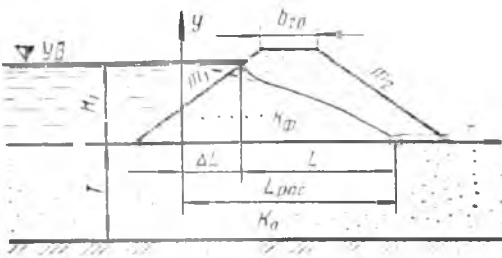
Расчетная схема фильтрации грунтовой плотины на водонепроницаемом основании.
